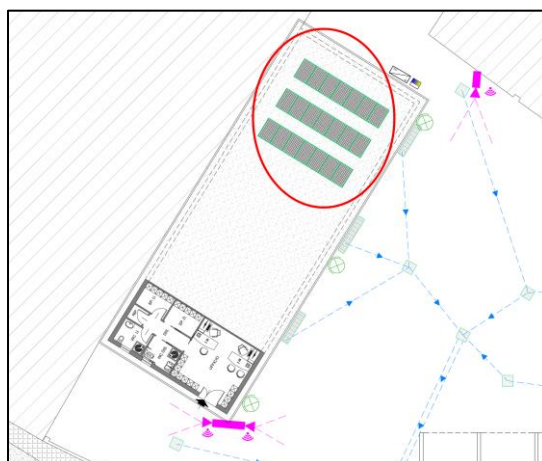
Planimetria di progetto: realizzazione di impianto fotovoltaico sul corpo di fabbrica esistente
